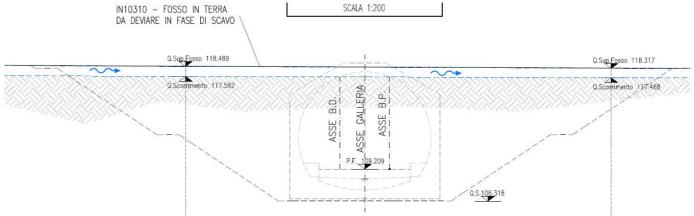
Stato di fatto, sezione con la posizione originaria del canale, scavi e struttura della galleria artificiale.
